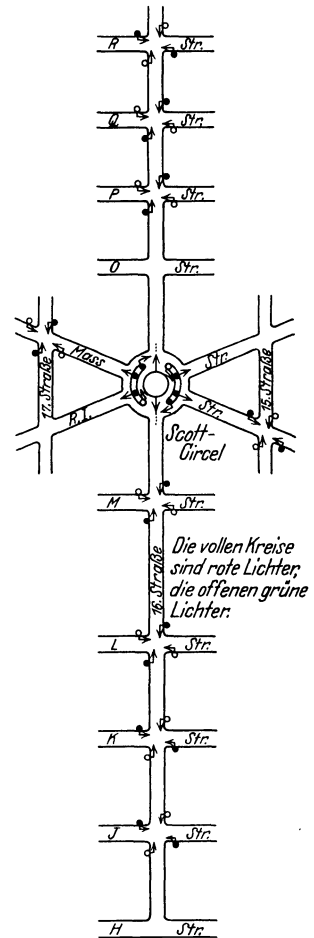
Fahrregelung auf der Scott-Circular mit 16. Straße, Washington (V.St.A.).
